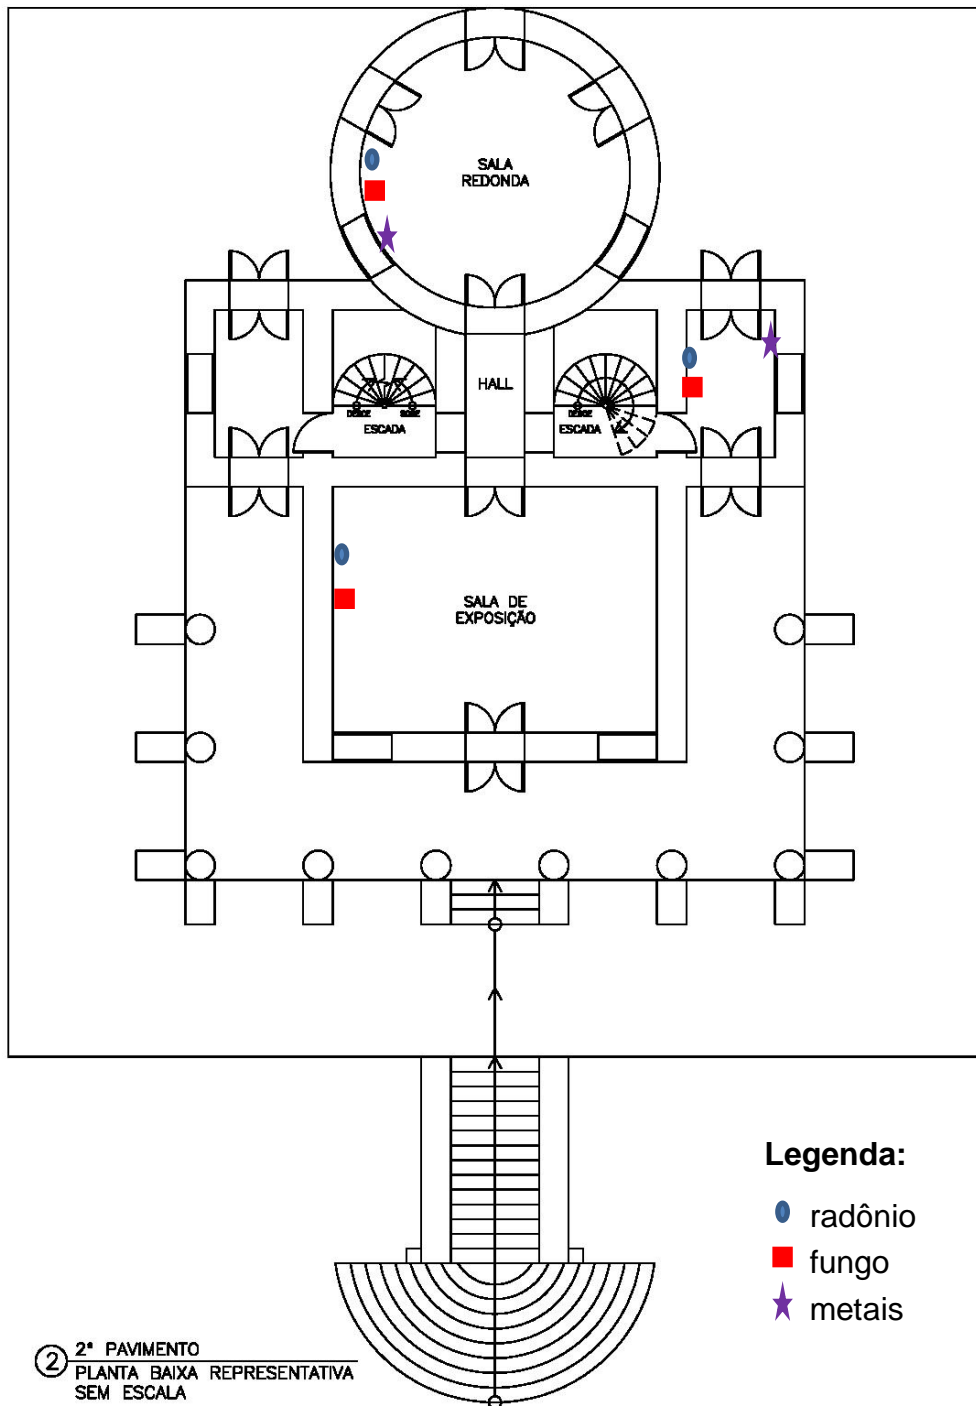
Planta baixa, Prédio A, segundo pavimento.
